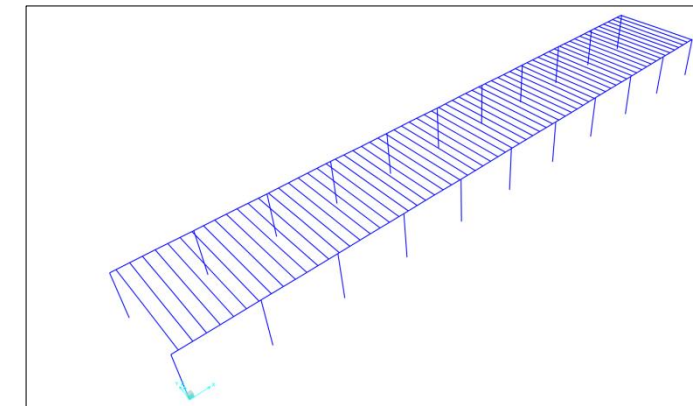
b. Modelización de la estructura de hormigón prefabricado. Almacén
